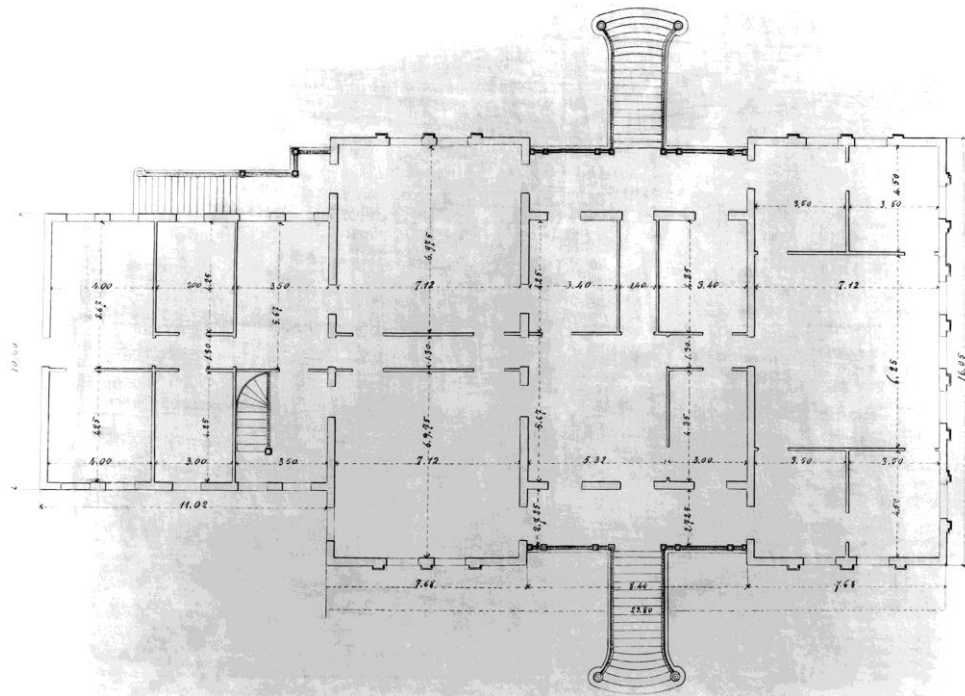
planta baixa com o bloco de serviço acrescido na construção
